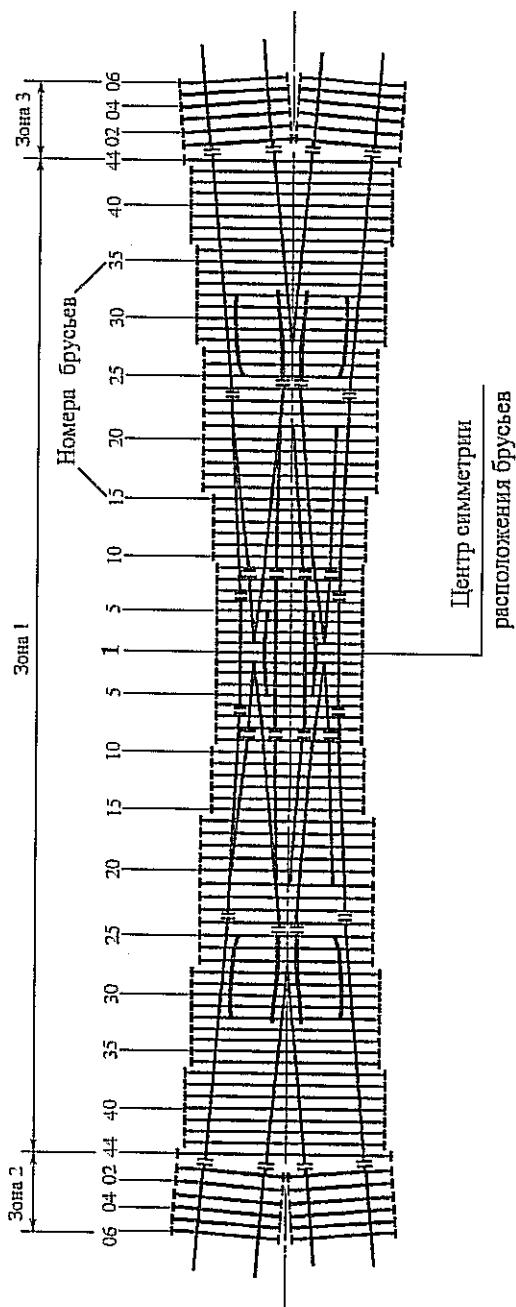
Схема расположения железобетонных брусьев двойного перекрестного стрелочного перевода
